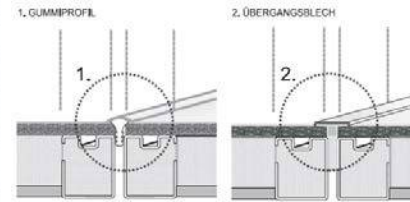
Modulverbindung – Decke, andere Verbindungsvariante
